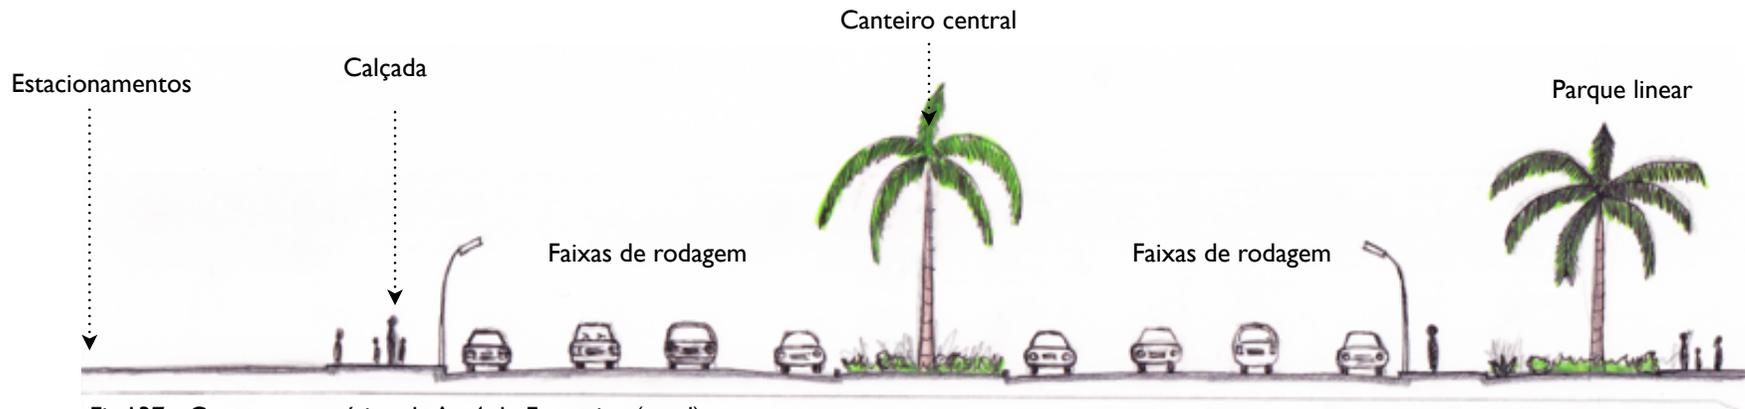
Corte esquemático da Av. 4 de Fevereiro (atual)
